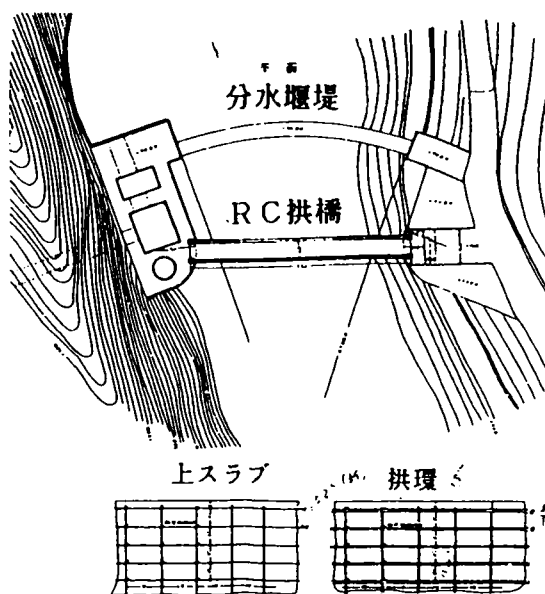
布引水源分水堰堤付属橋、平面図及び配筋図<sup>30)</sup>
